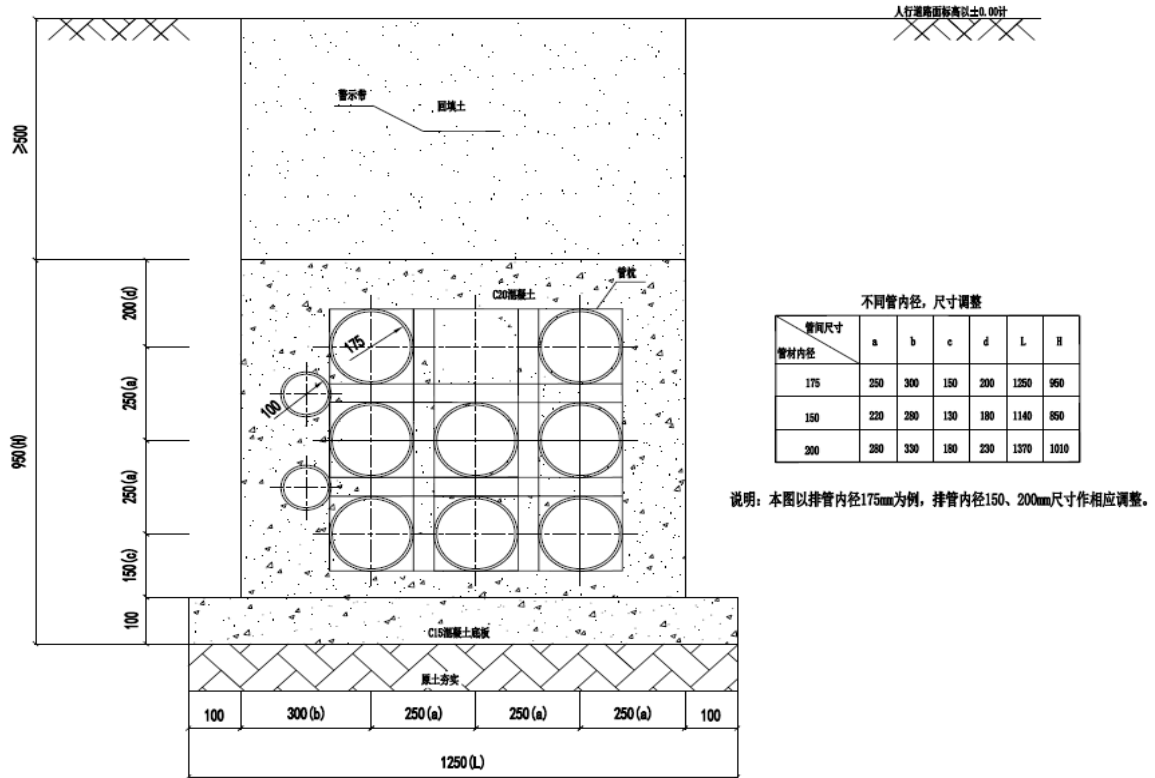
排管 3×3-1（8+2 型）混凝土方包
